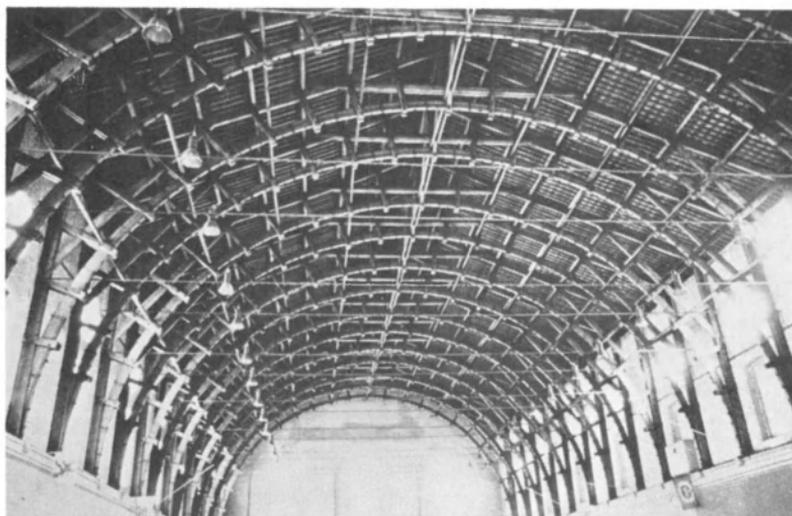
Intérieur du manège de la caserne des Écoliers construit en 1837.
